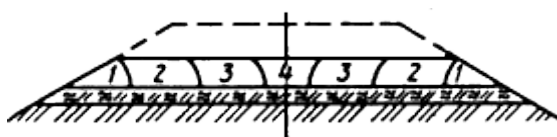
Схема возведения земляного полотна бульдозером с сохранением мохорастительного слоя в основании: 1, 2, 3, 4 - последовательность укладки первого слоя грунта
